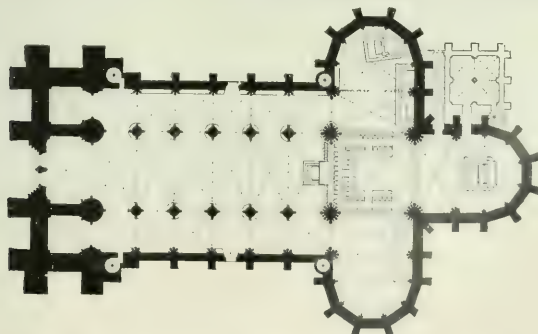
Elisabethkirche zu Marburg. Grundriß. S. 67 f.
